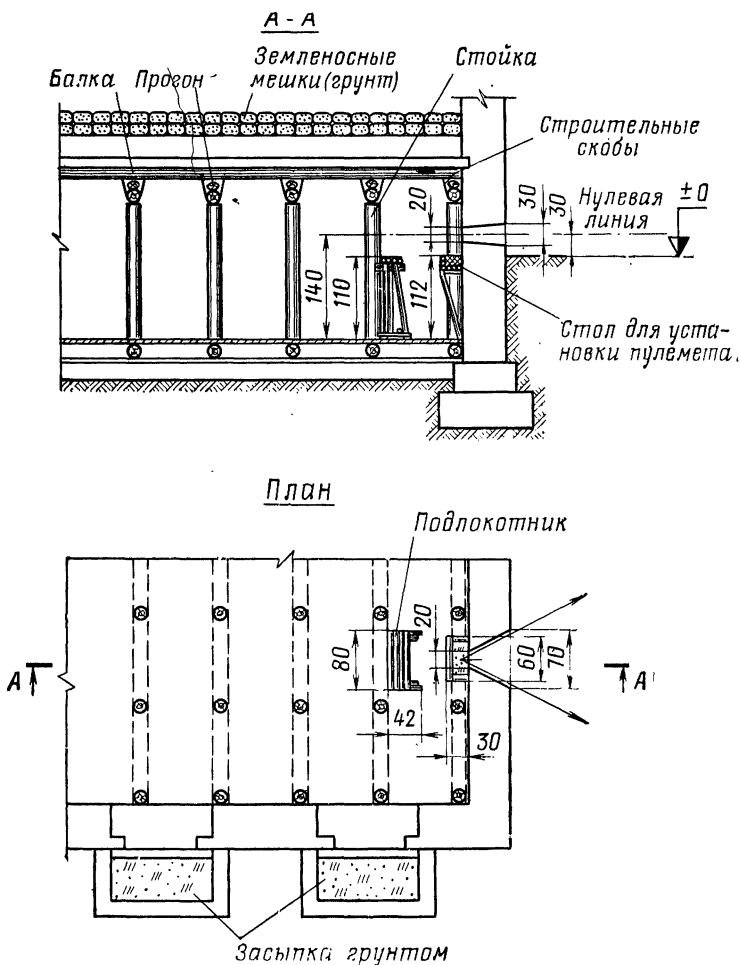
Приспособление подвала здания для стрельбы из пулемета
